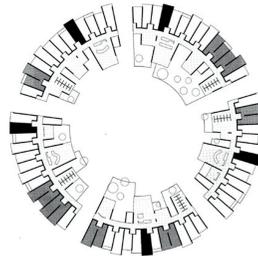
Grundriss des Tietgenkollegiet Kopenhagen
